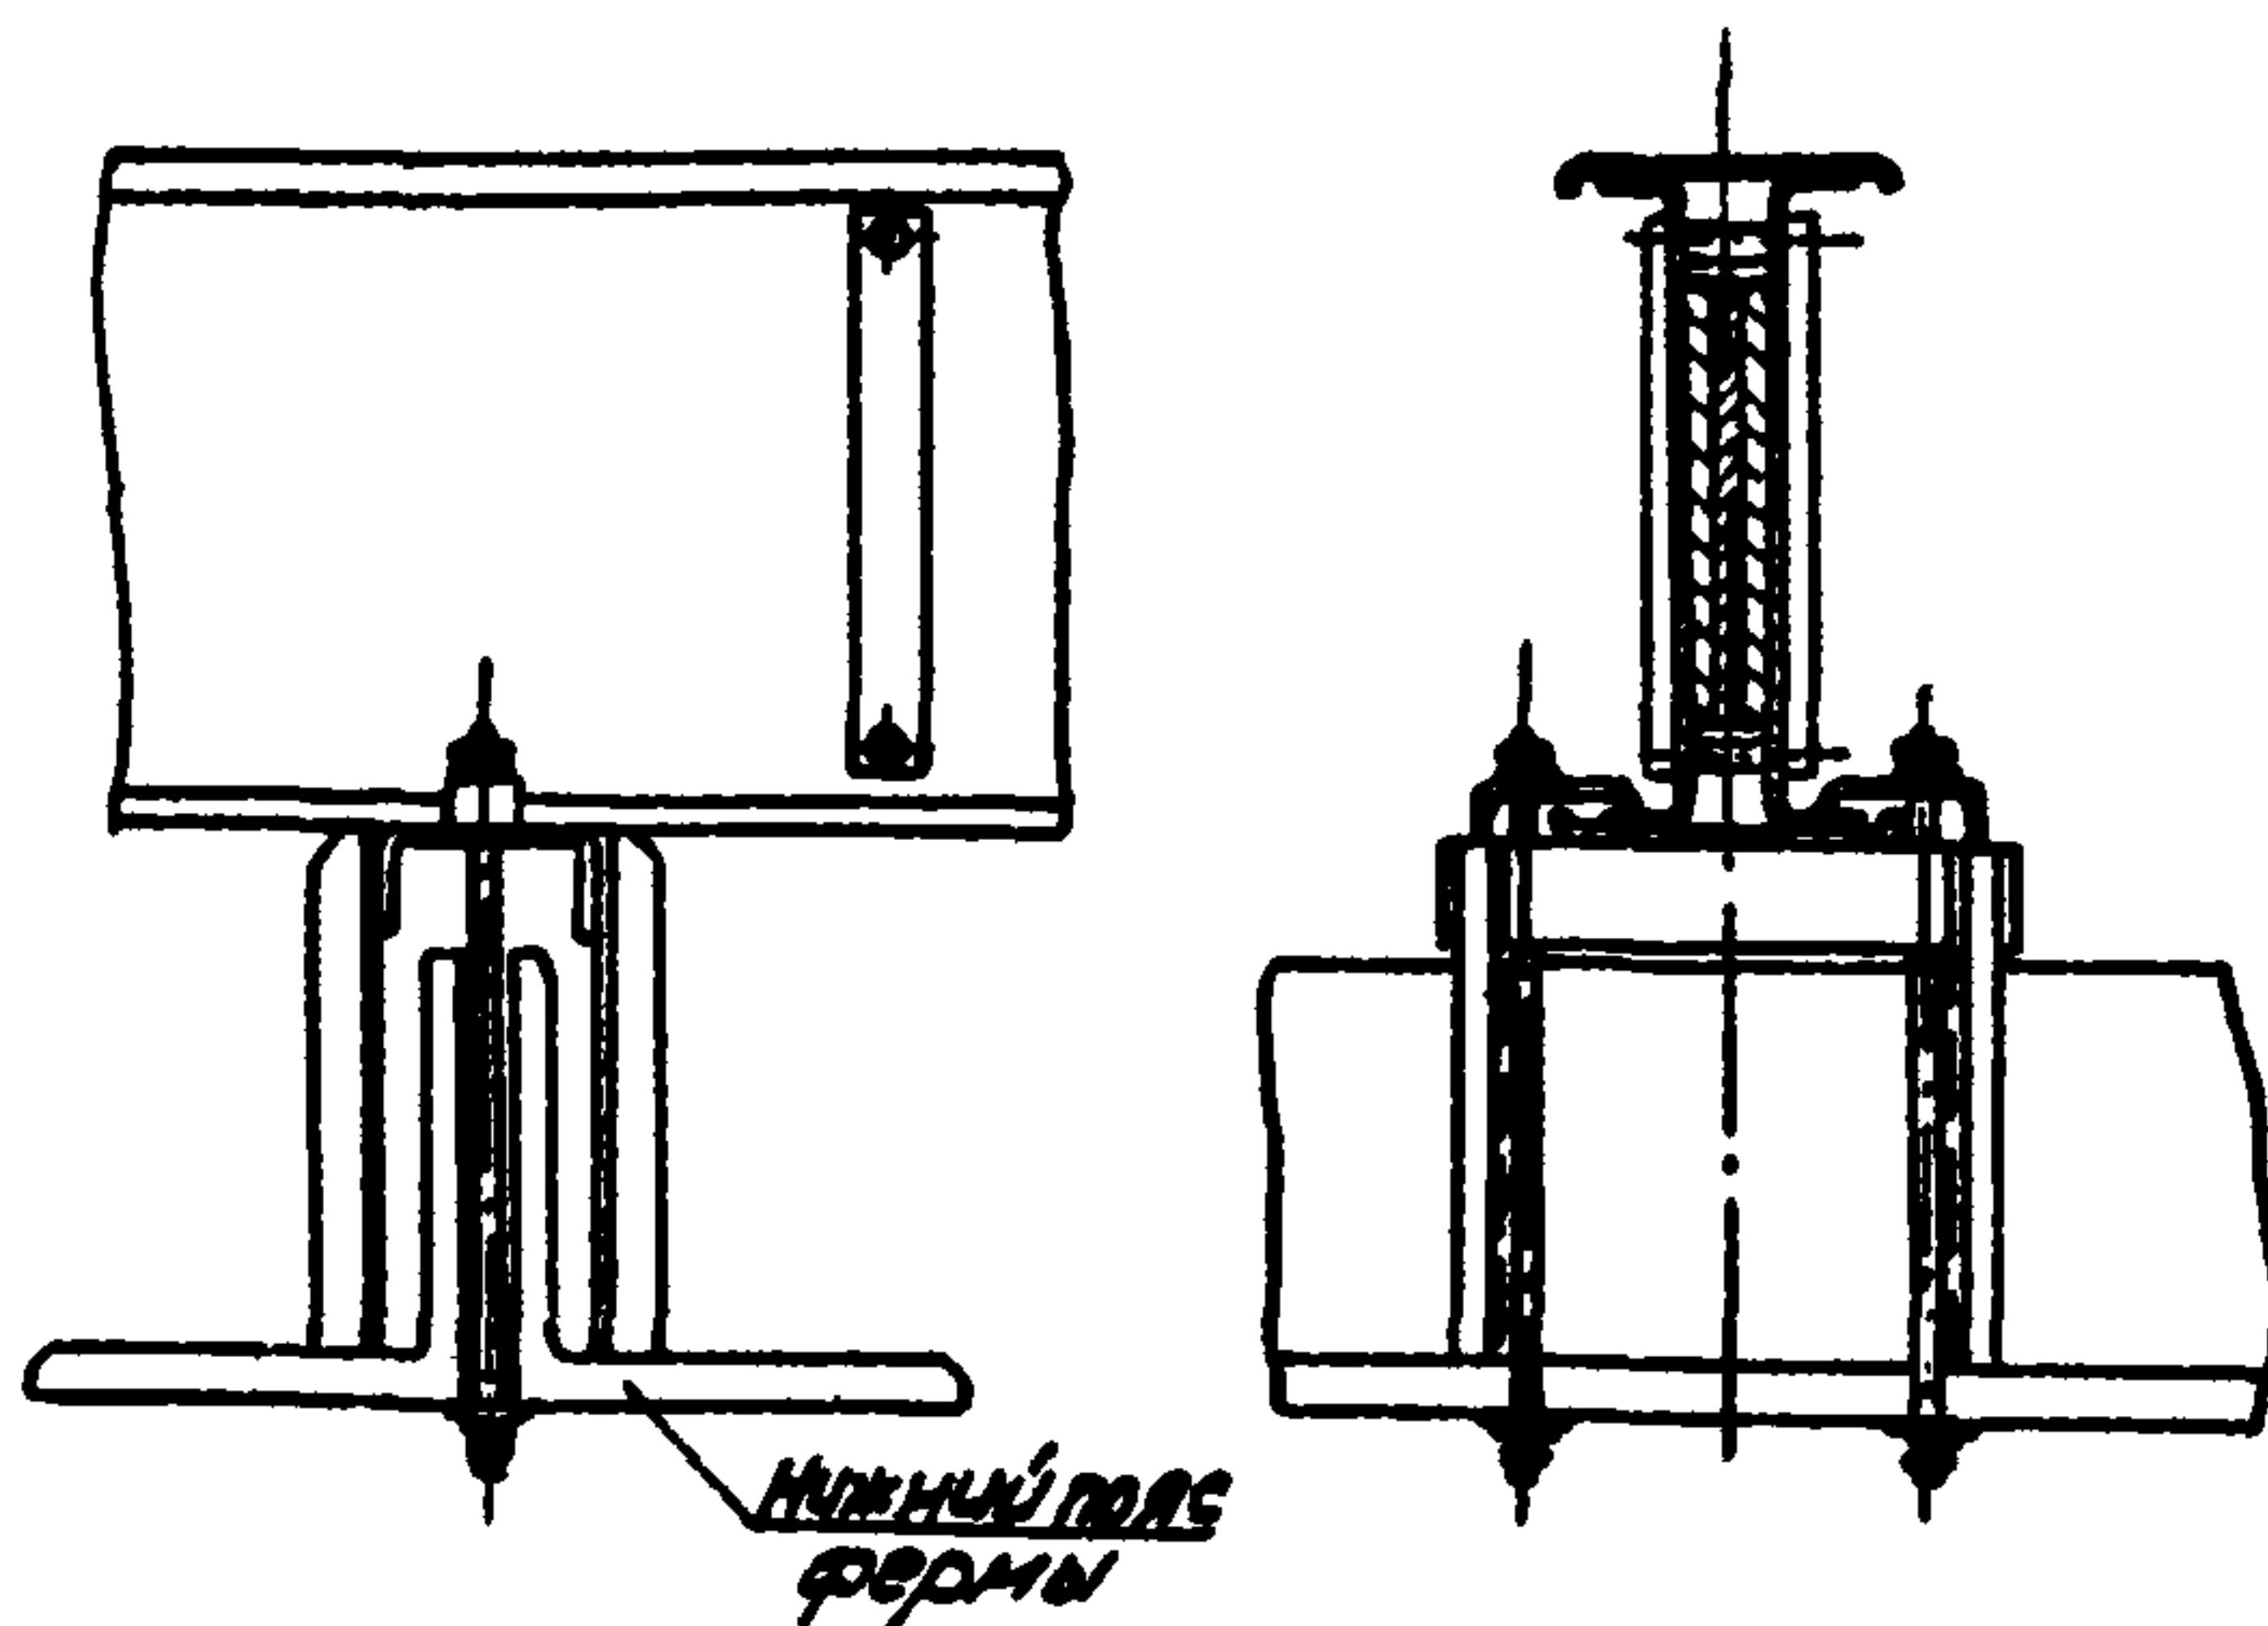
Крепление шинопровода на нижнем поясе металлических ферм.
